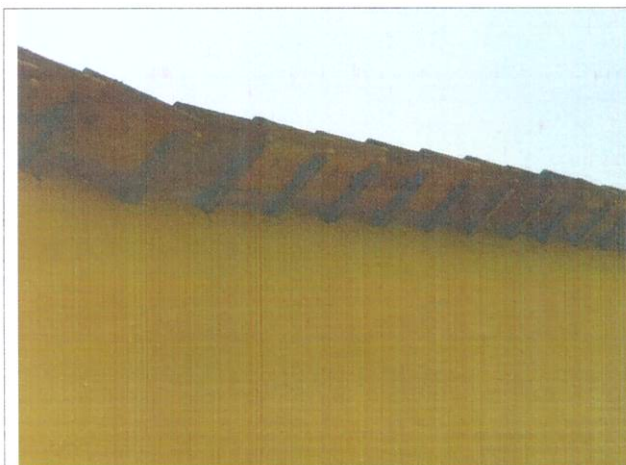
Fissura no fechamento entre a telha e a estrutura de sustentação do telhado
